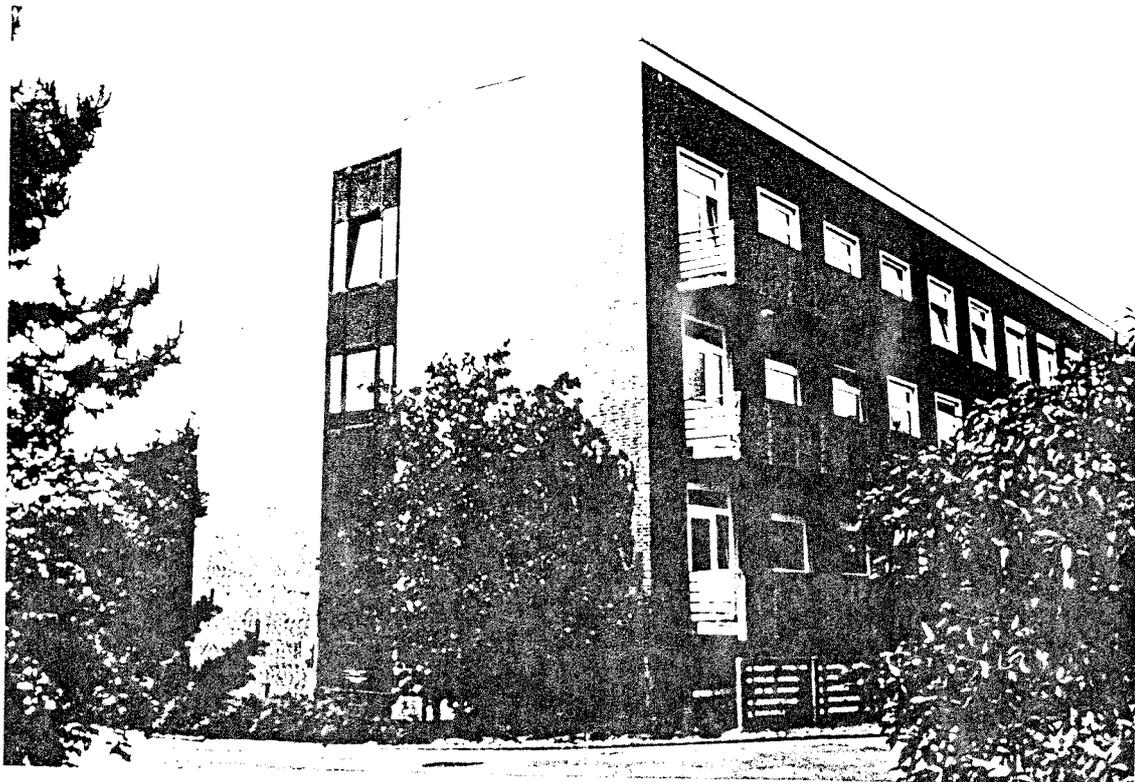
Fassadenansicht Gebäude B (rechter Gebäudeflügel nicht saniert)
